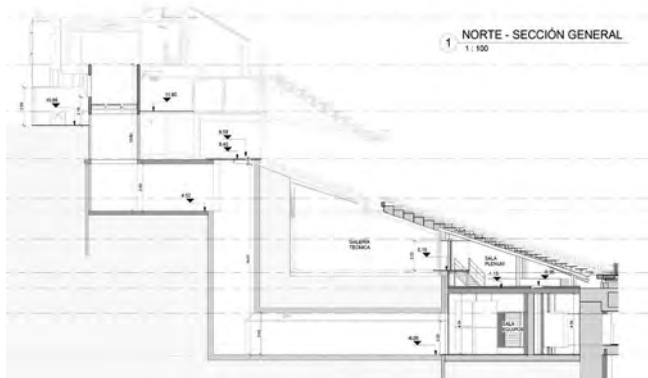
Sección de galería y paso inferior de las ventilaciones desde la sala de hipogeo. Imagen procedente proyecto de ejecución.
